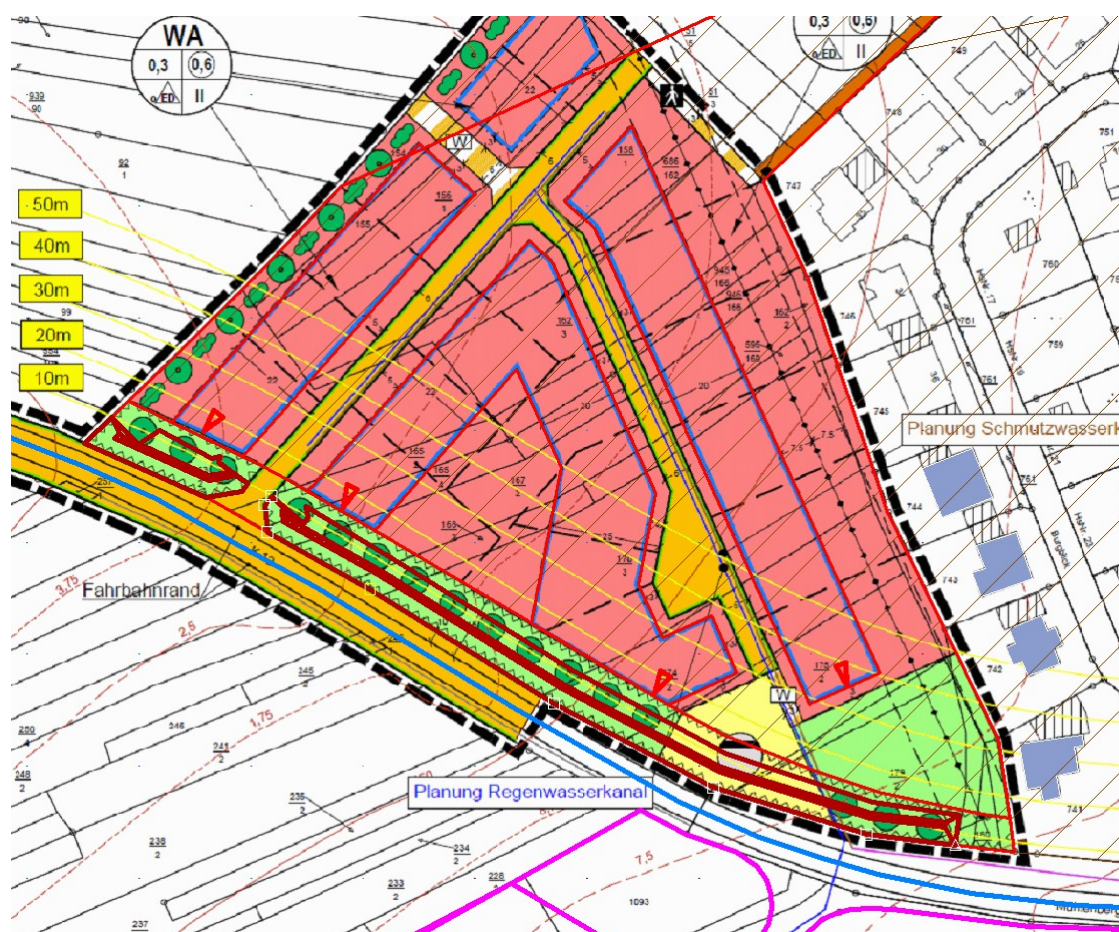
Ausschnitt Bebauungsplan mit Einzeichnung des Lärmschutzwalls
